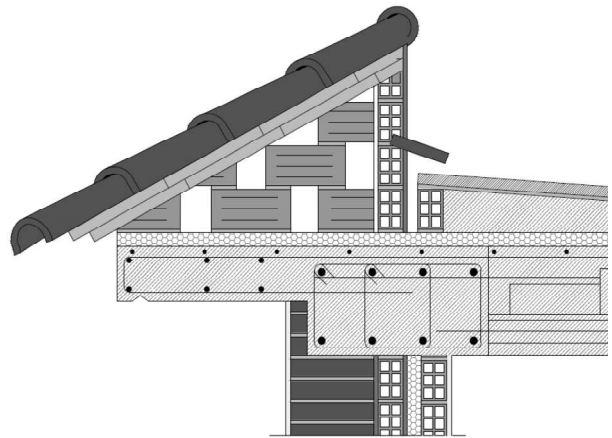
Fachada-Cubierta. Zona oeste. Estado rehabilitado.
